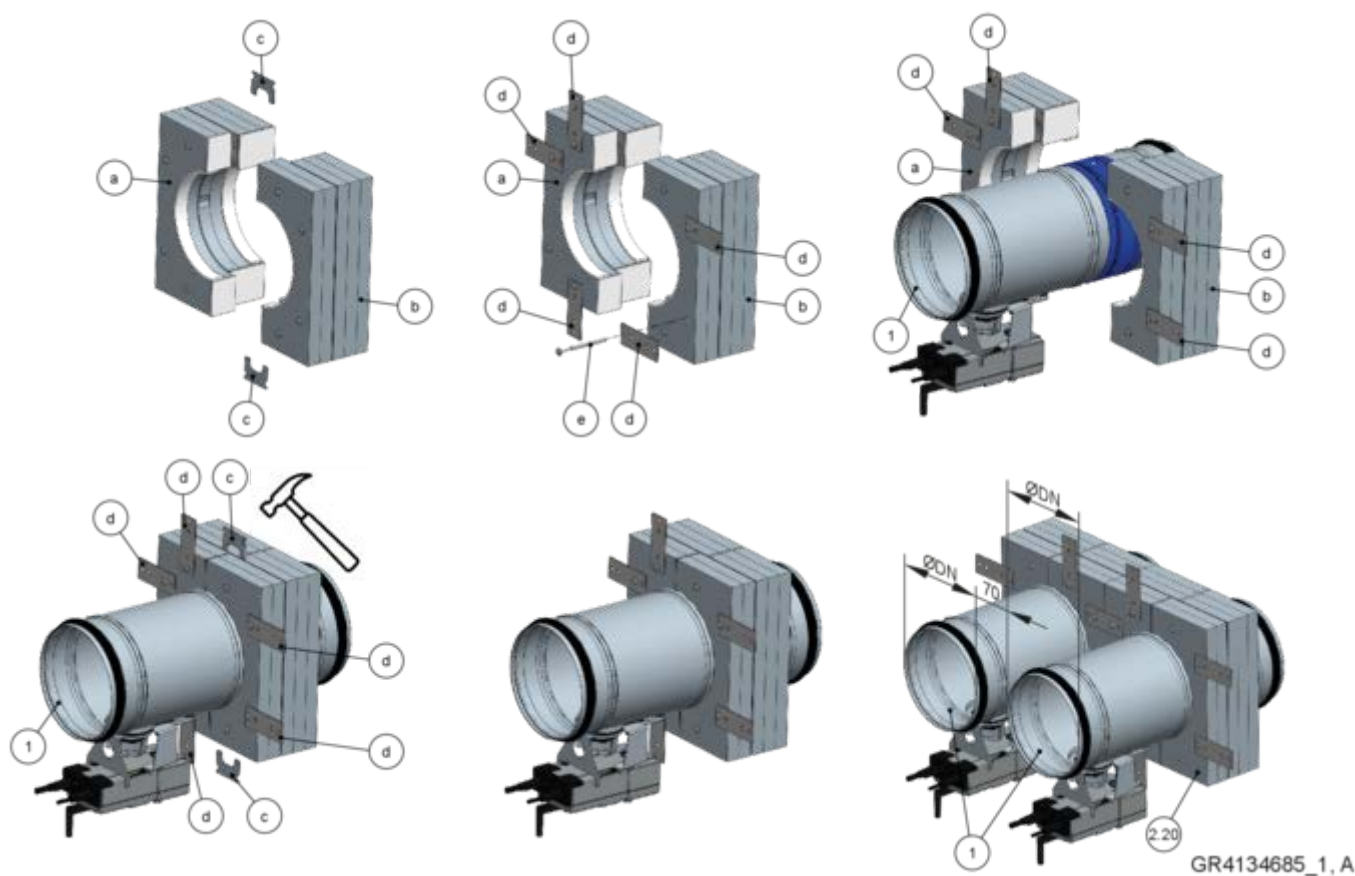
Leveranspaket och installation av installationskit GL2 för torr installation utan murbruk
